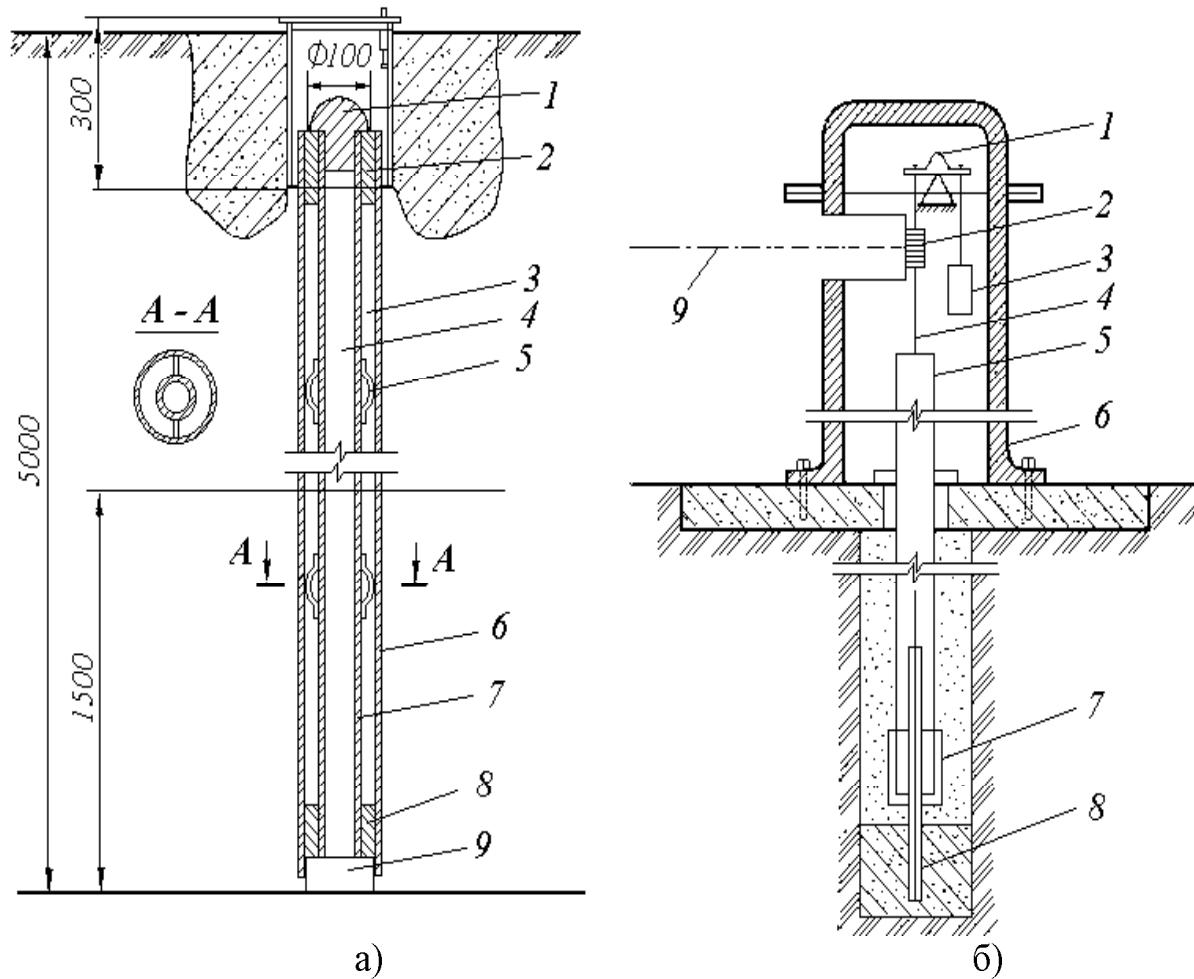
Глибинний репер: а) трубчастий репер, що закладається бурінням: 1 – запресована бронзова головка з хрестовиною; 2, 8 – сальники; 3 – мазут; 4 – цемент; 5 – наварний ліхтар зі сталі; 6 – труба ( $\varnothing 150$  мм); 7 – труба ( $\varnothing 60$  мм); 9 – піддон металевий; б) репер з гнучкою реперною штангою: 1 – важіль; 2 – шкаловая марка; 3 – вантаж; 4 – інварний дріт; 5 – захисна труба; 6 – труба-люк; 7 – сальник; 8 – шток; 9 – горизонт приладу
